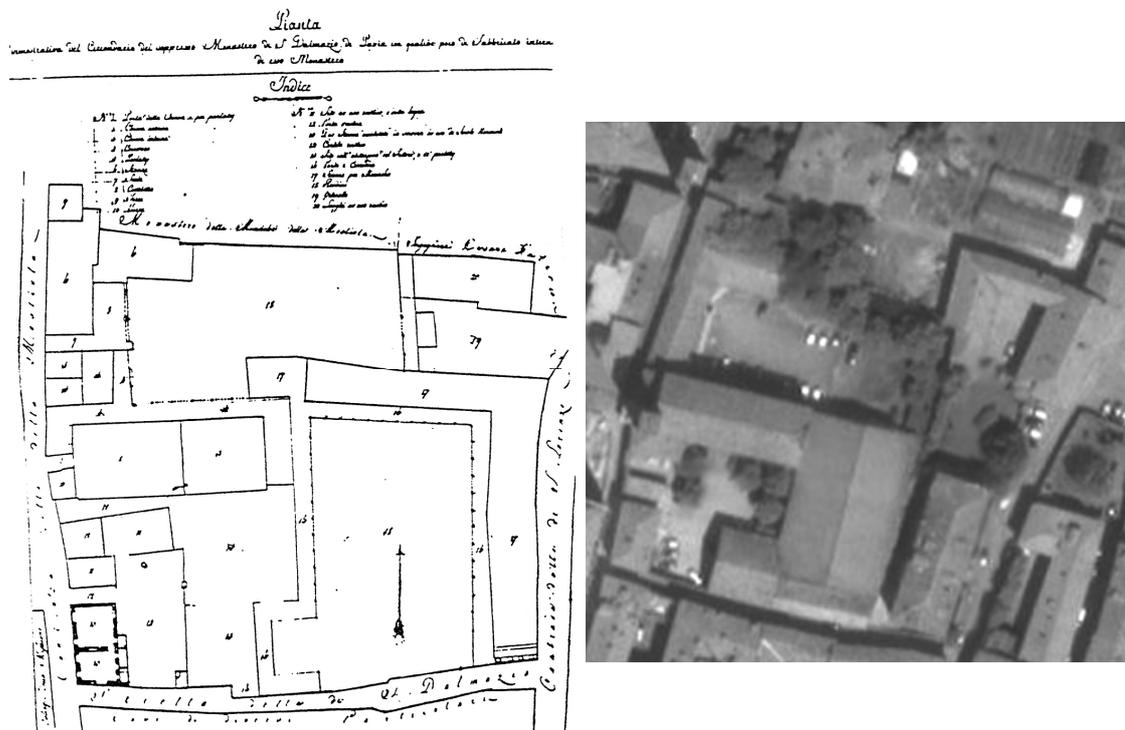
Planimetria del monastero di San Dalmazio in Pavia del 1790 (Archivio di Stato di Milano) e veduta aerea dello stato attuale
